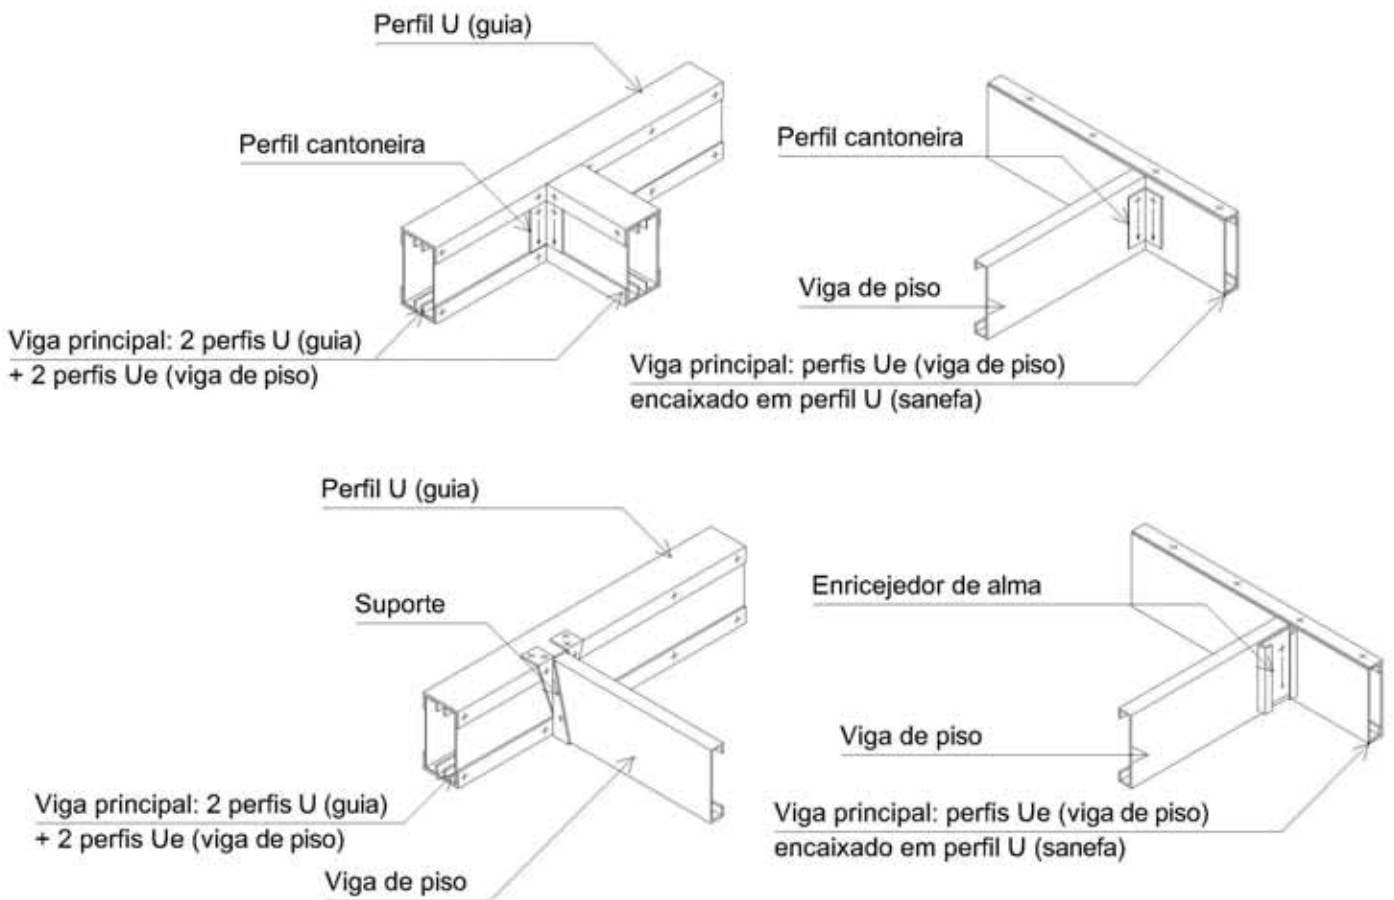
Tipos de vigas principais para apoio de vigas de piso.
